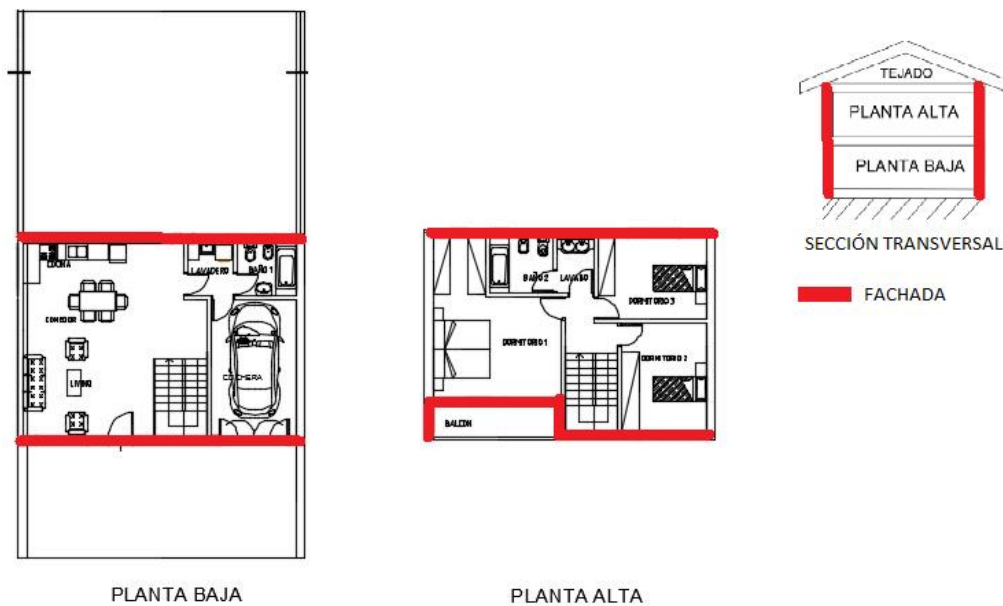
Cerramiento fachada en planta baja, planta alta y sección transversal.
